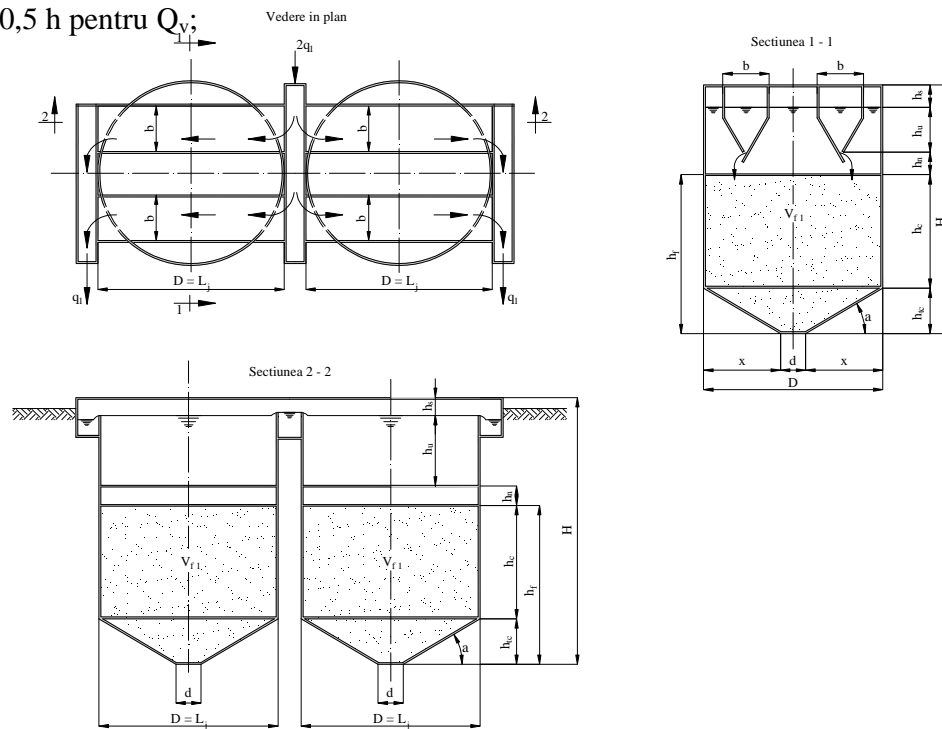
Decantare cu etaj. Dispoziție în plan și secțiuni caracteristice.
